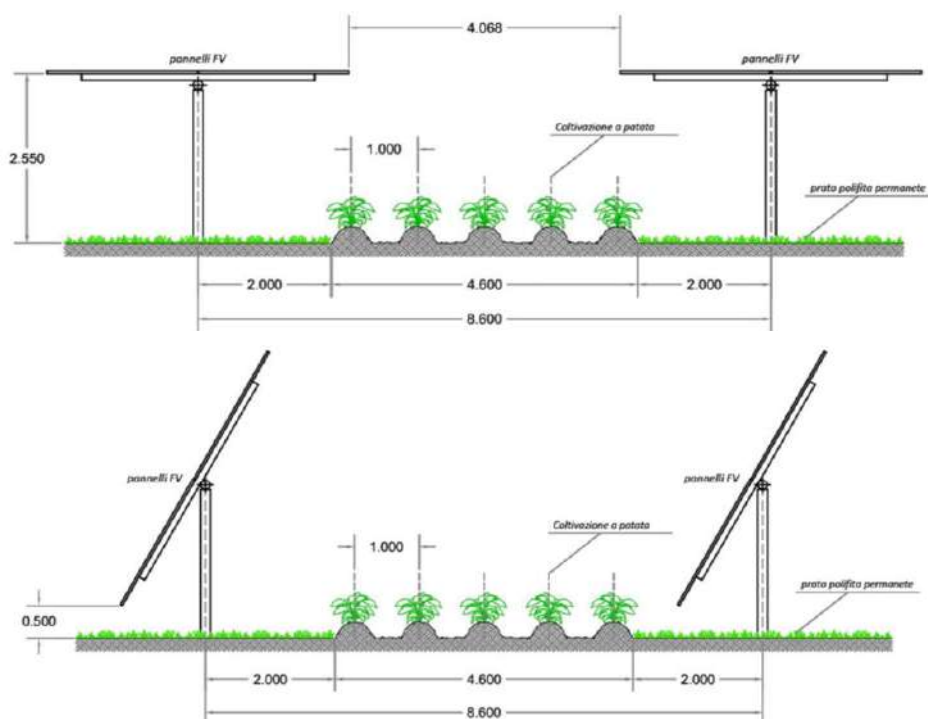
Sezioni tipo per gli impianti agri-voltaici con strutture di sostegno ai pannelli di tipo ad inseguimento solare monoassiale
